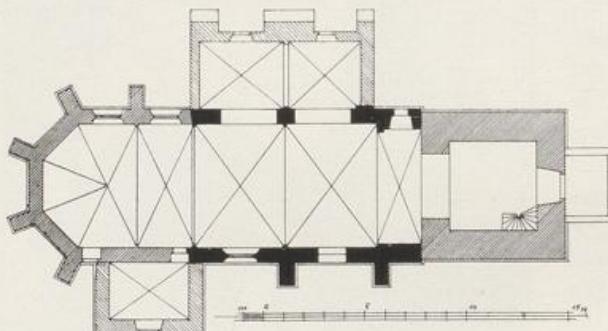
Stockheim. Grundriss der kathol. Pfarrkirche.
